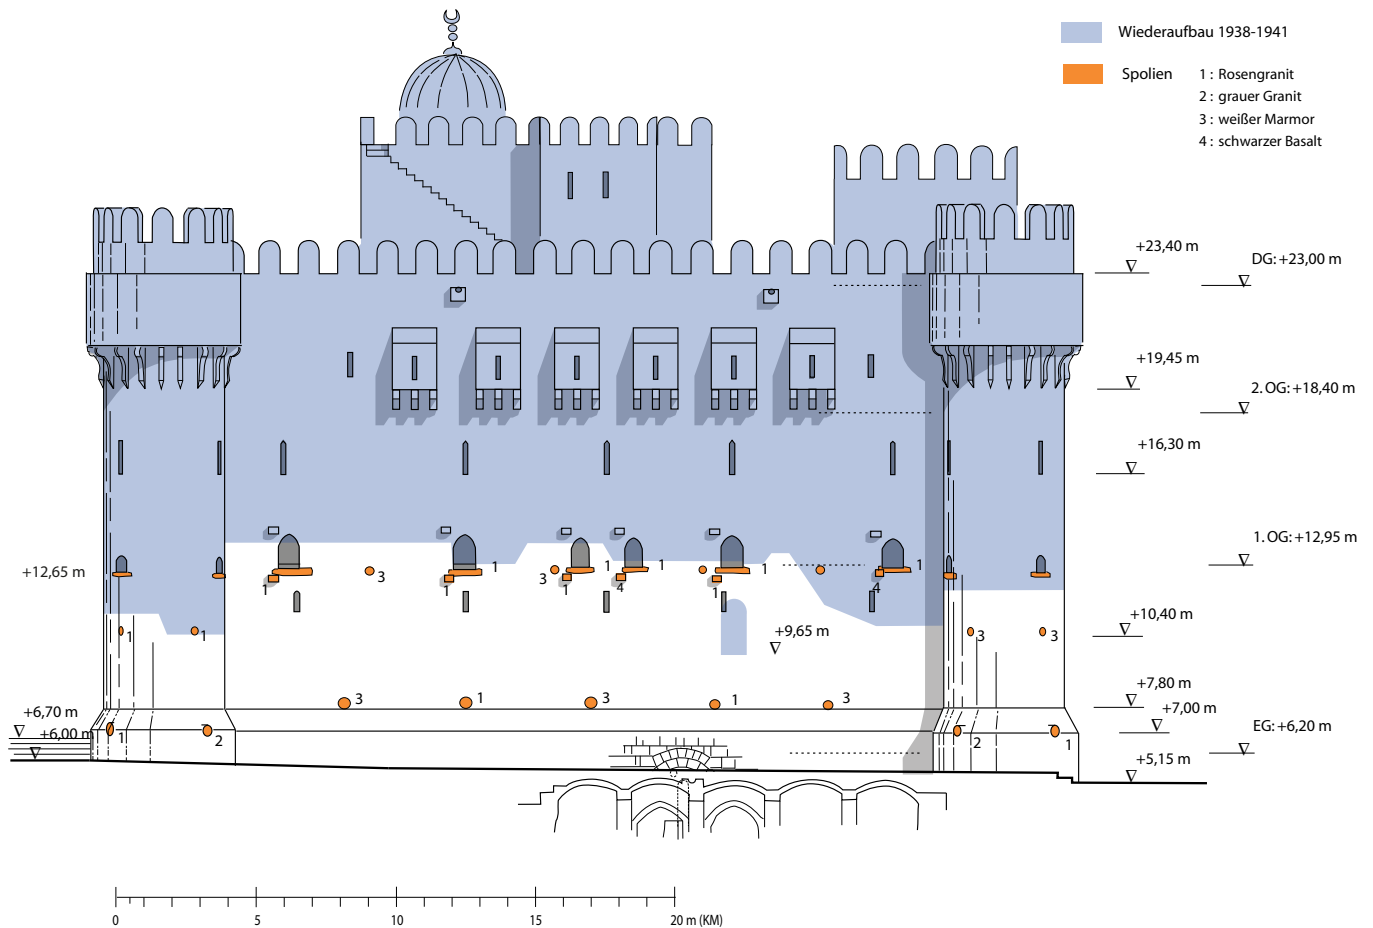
Hauptturm: wiederaufgebaute Westfassade.
